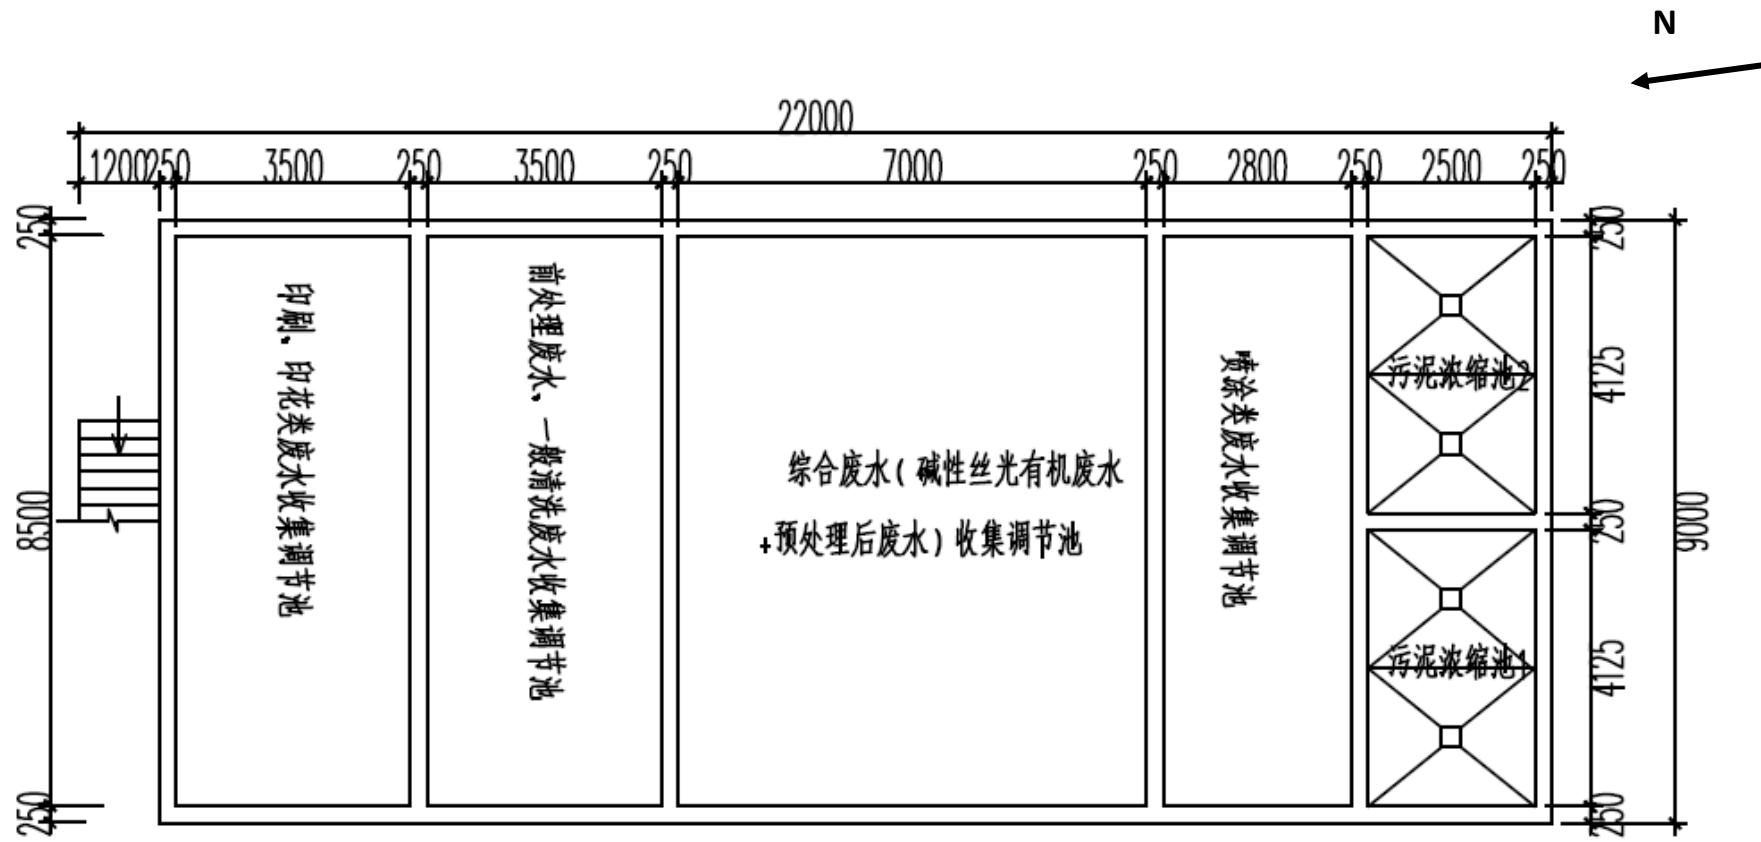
处理构筑物2一层平面布置图 (-2.5~1m)
